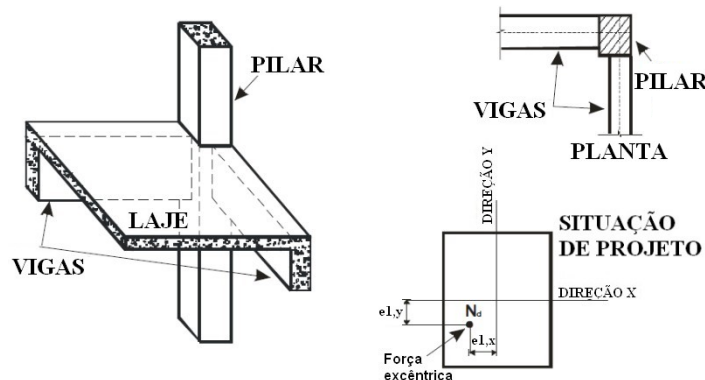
Arranjo estrutural e situação de projeto de pilares de canto (OMAR *et al.*, 2010)
